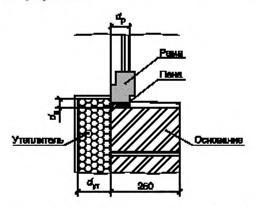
Схема узла примыкания оконного блока к стене
